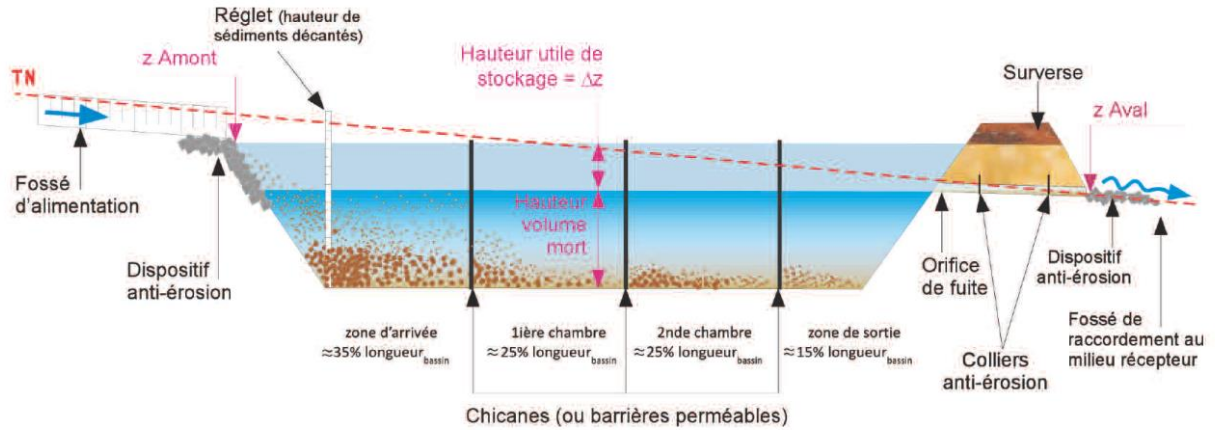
Coupe-type d'un bassin de décantation (source : [21])
